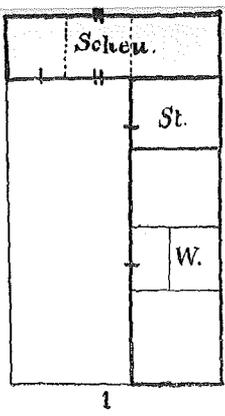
30. Grundrisse von heanzischen Bauernhäusern.
